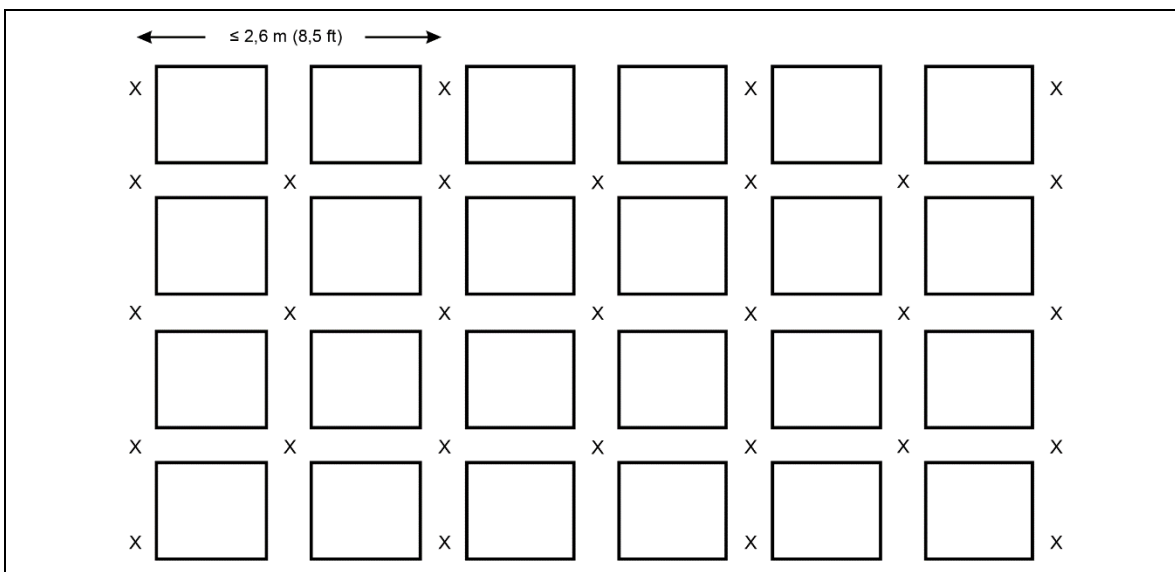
Vista en planta de una configuración alternativa de rociadores intermedios para estanterías múltiples
